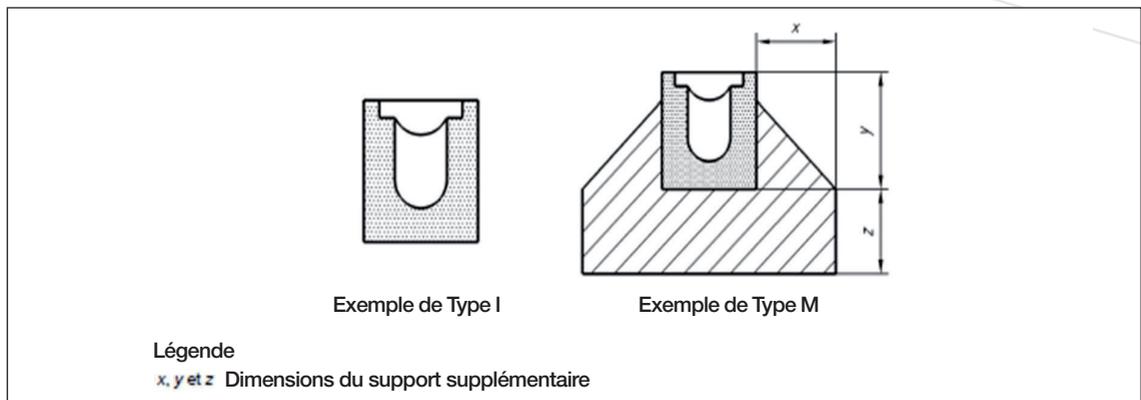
Exemples de caniveaux de Type I et de Type M [1]
